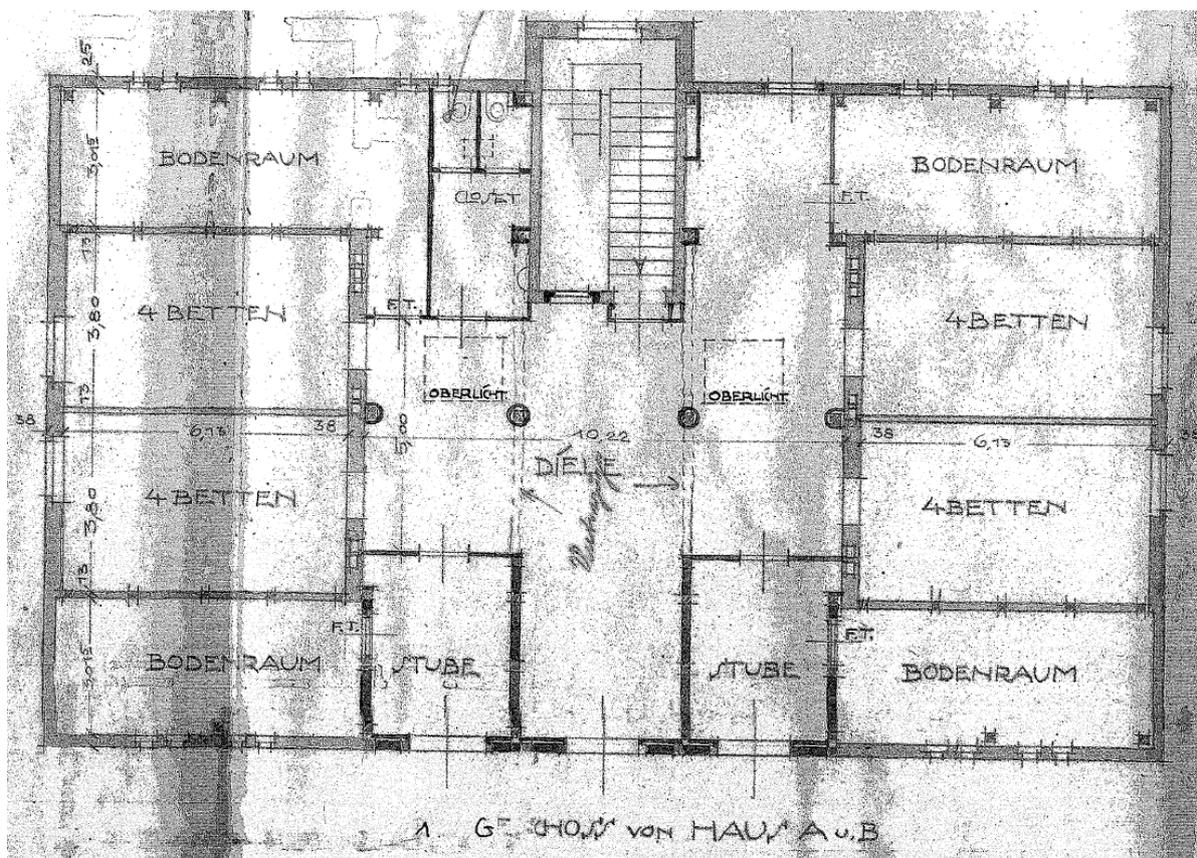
Grundriss Obergeschoss Haus A und B<sup>73</sup>
